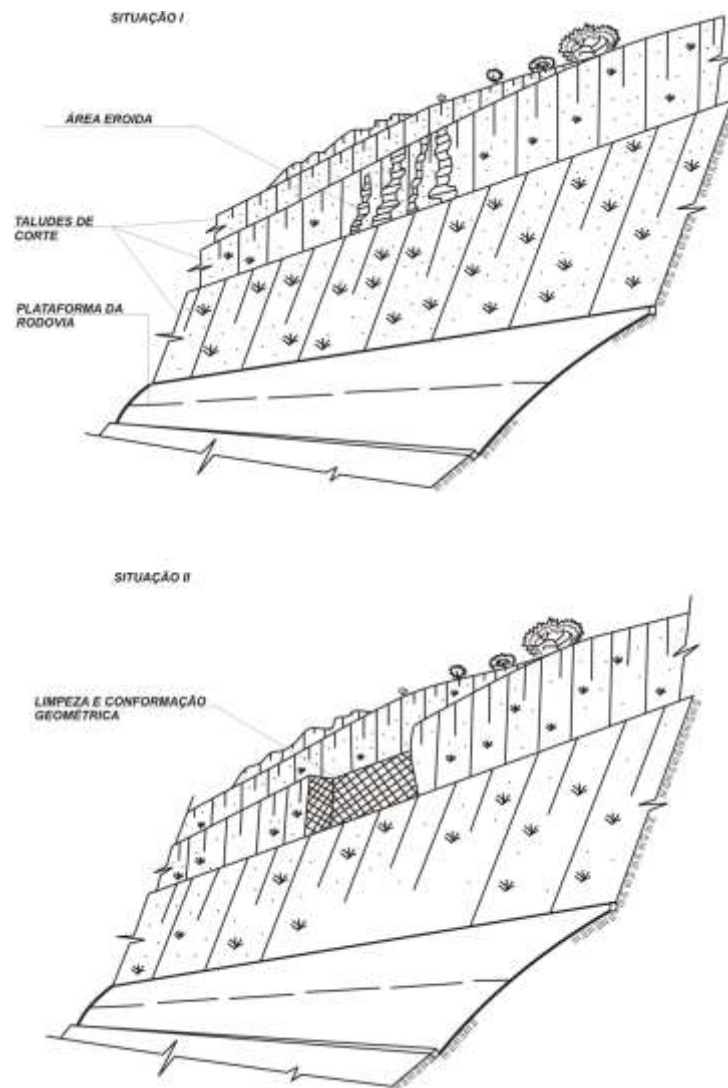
Projeto tipo 8– Solo-cimento ensacado (situação I e II).
